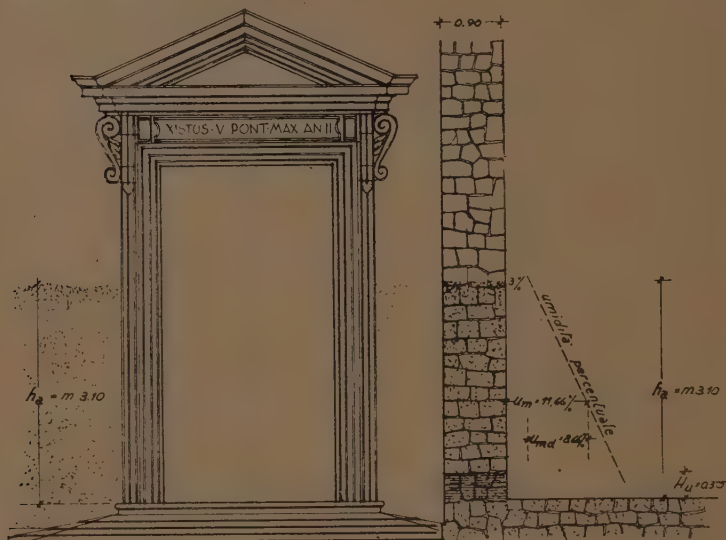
Vista e sezione del muro della « Sapienza ».
